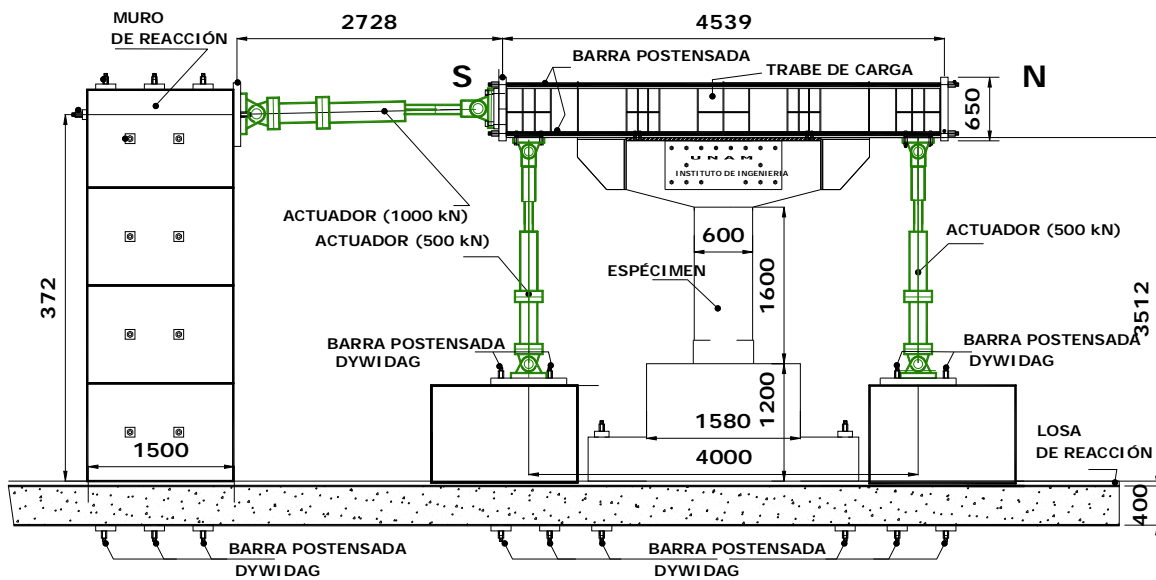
Esquema de ensayo de espécimen (dimensiones en mm)
